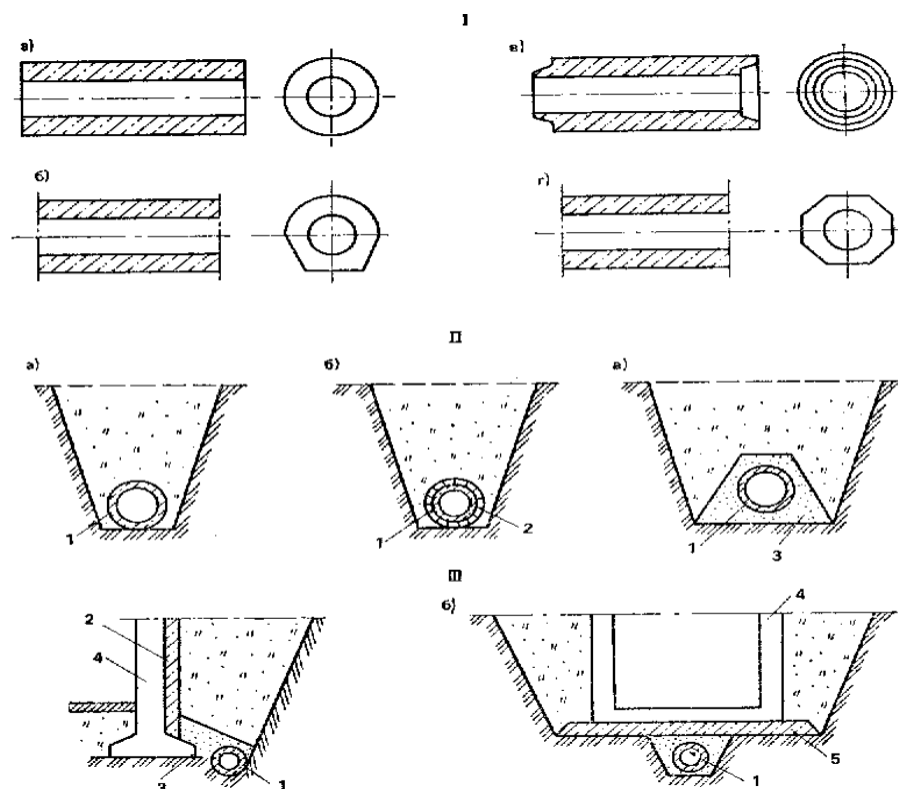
Конструкции дренажей с применением трубофильтров.
